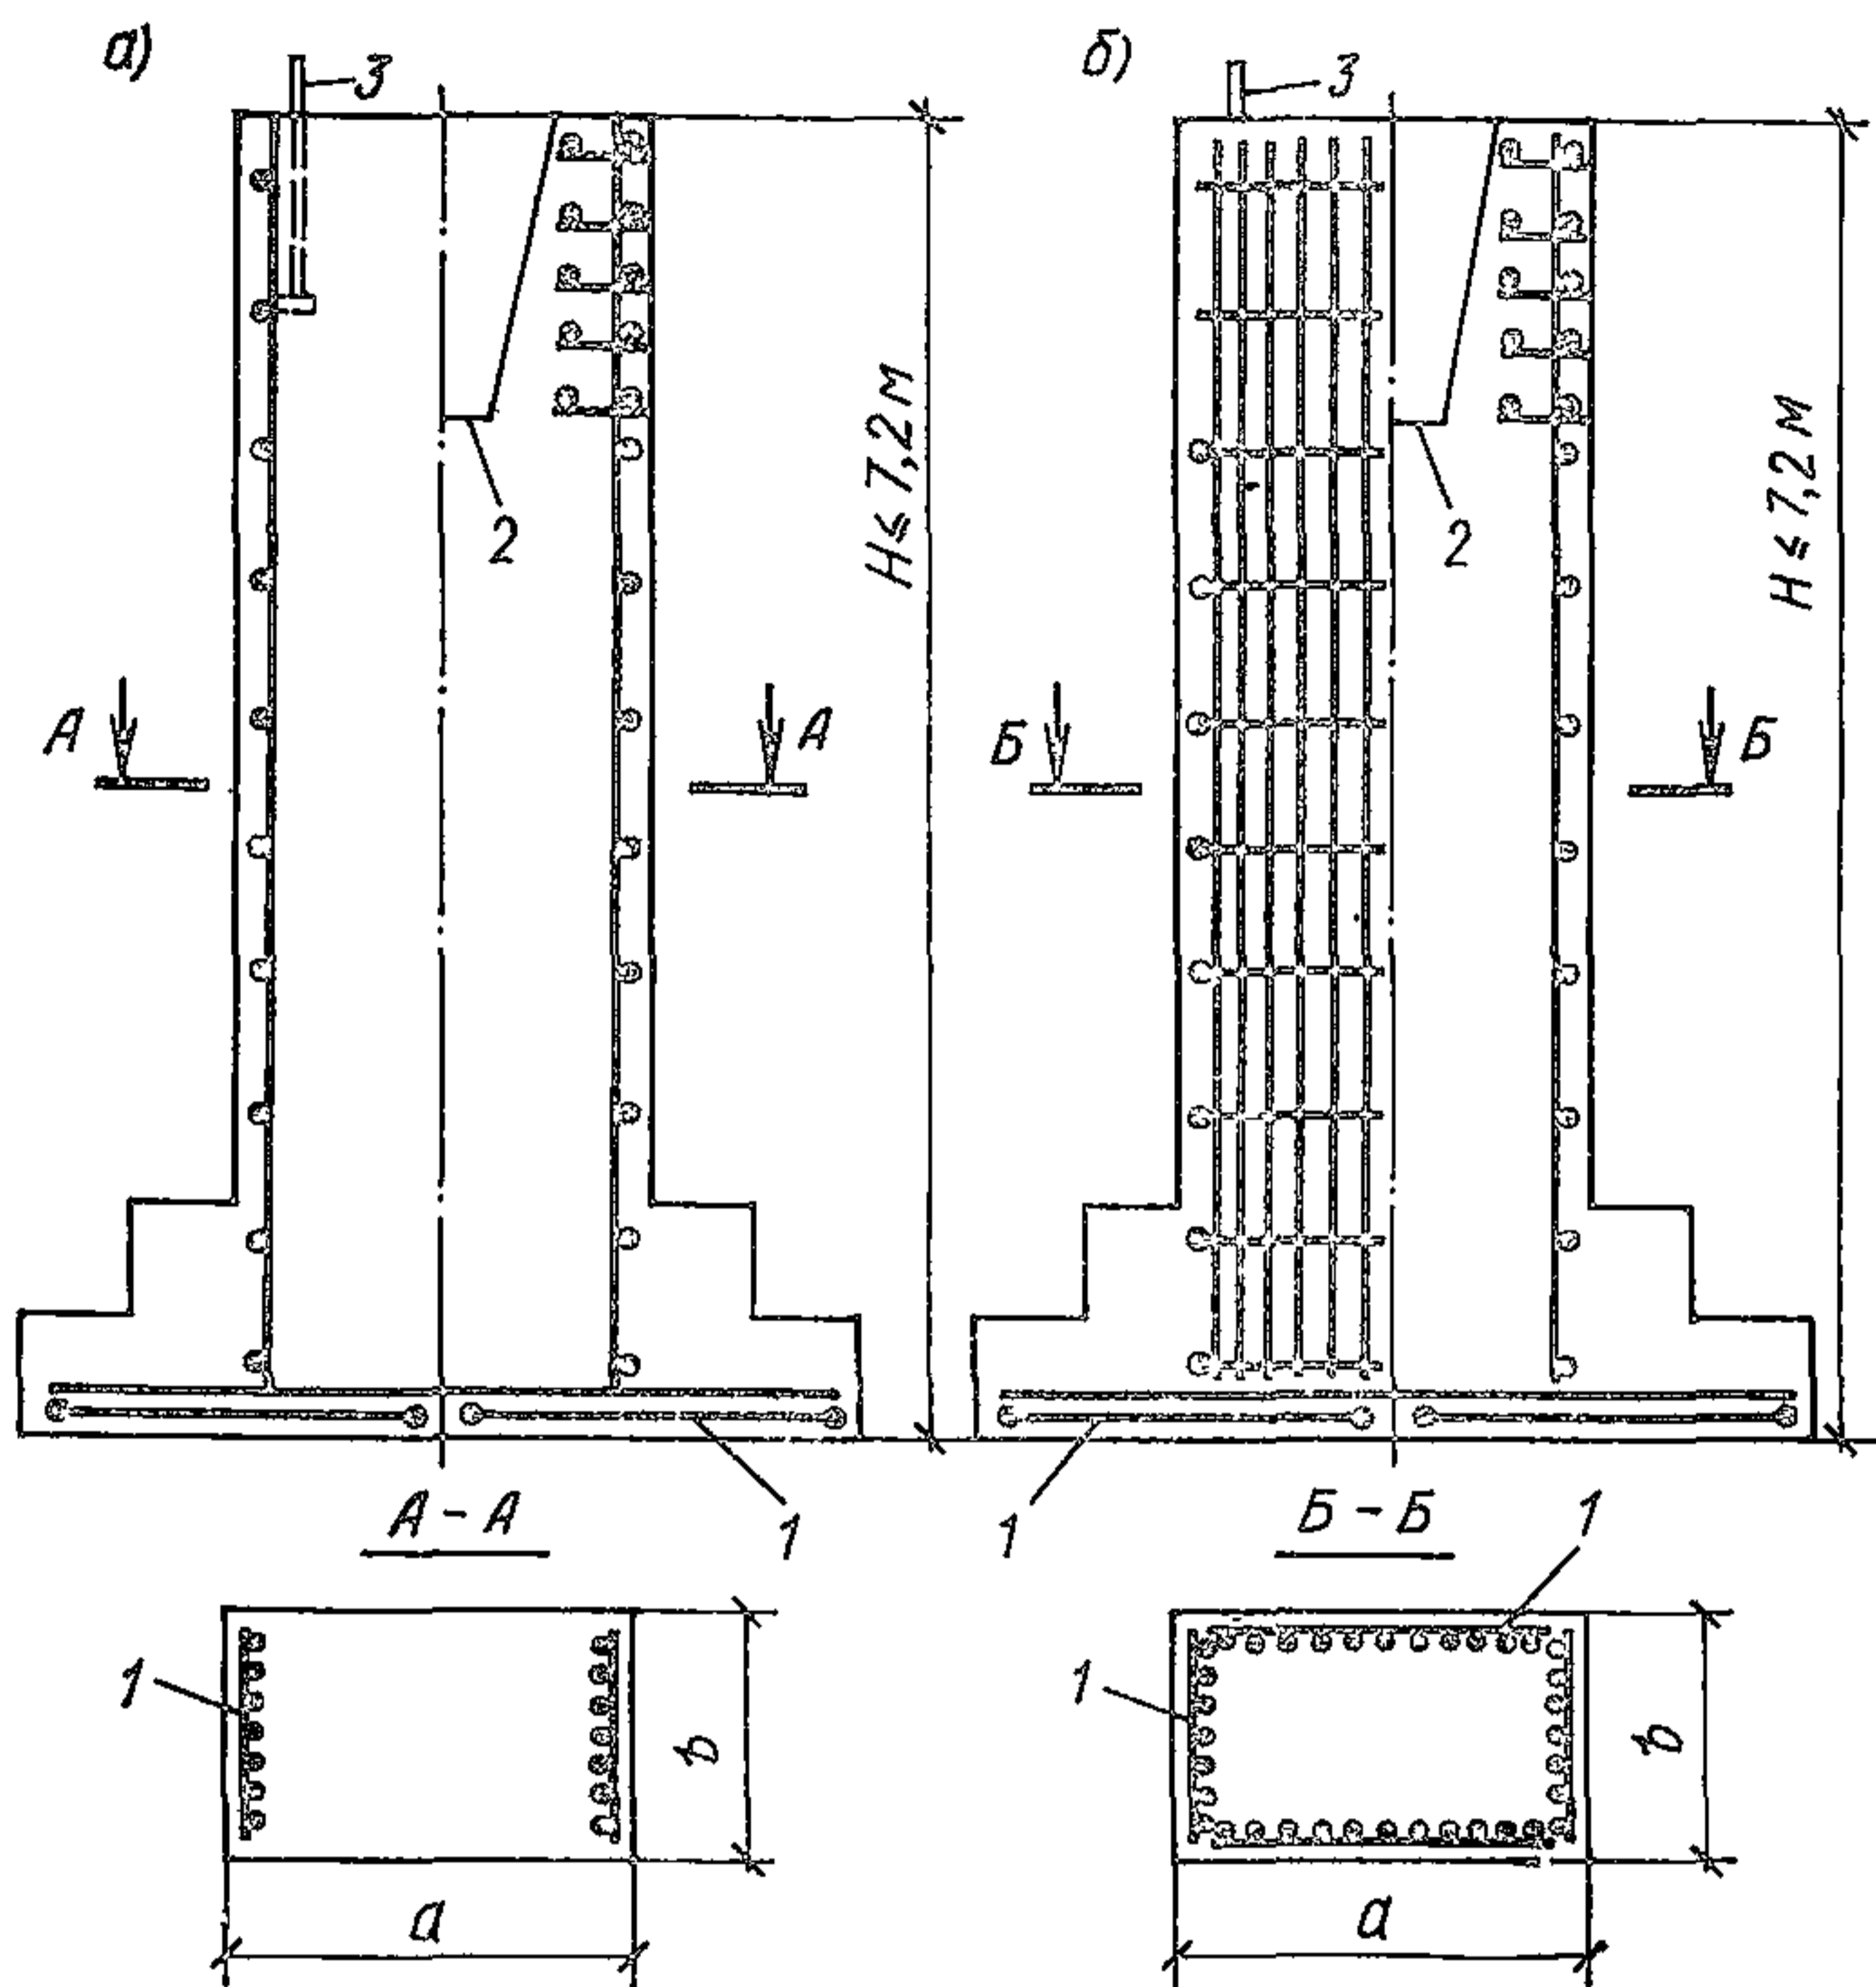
Армирование фундаментов колонн сварными сетками с навеской их на опалубку ($\mu \leq 0,3\%$)
